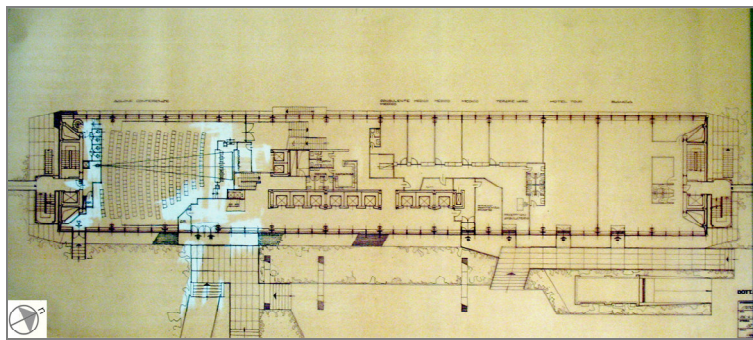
proposta di ristrutturazione generale – pianta piano terra – variante n°1
